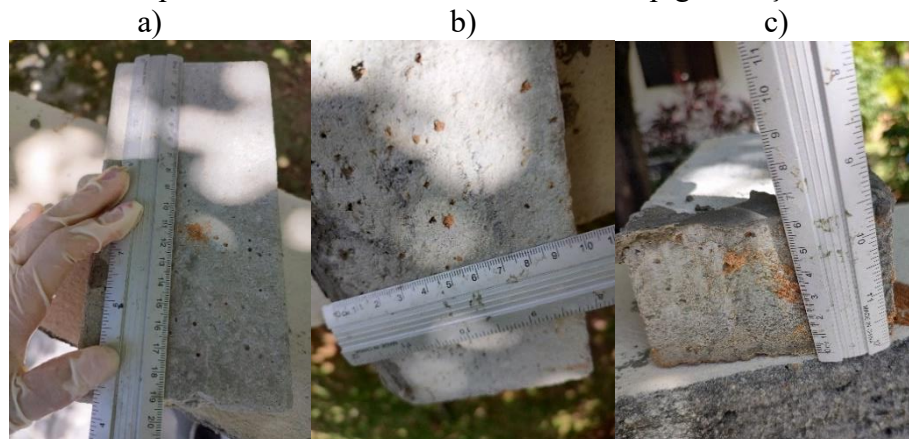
Dimensões paver em concreto convencional, com pigmentação vermelha.
